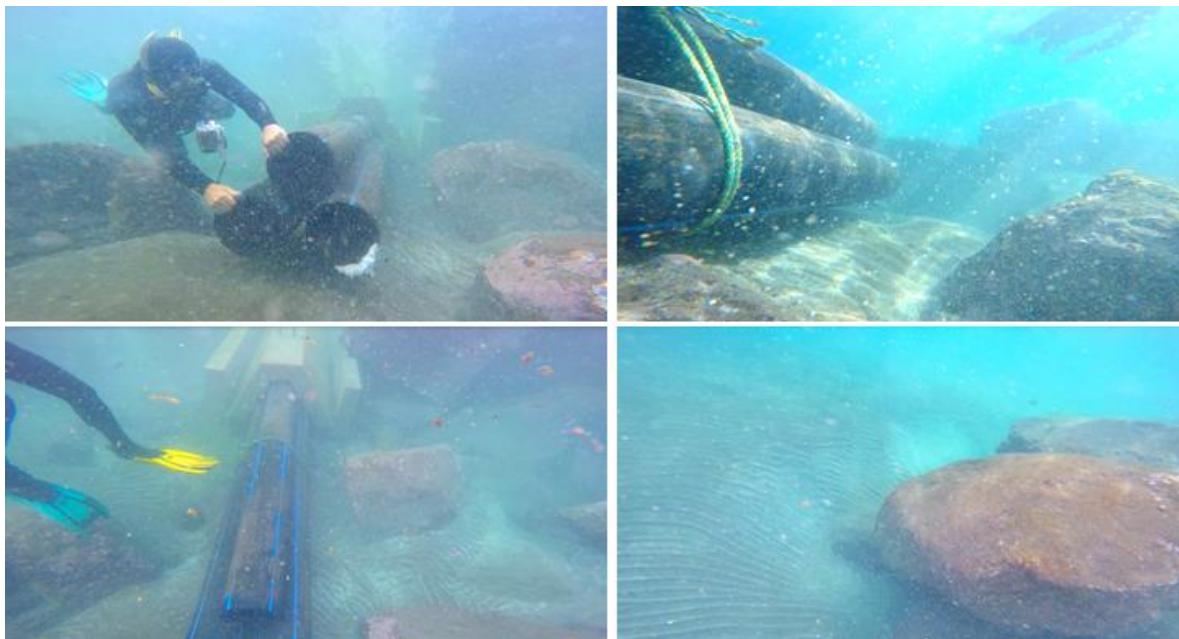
Canalización a pie de escollera para la entrada de los dos cables submarinos a tierra
